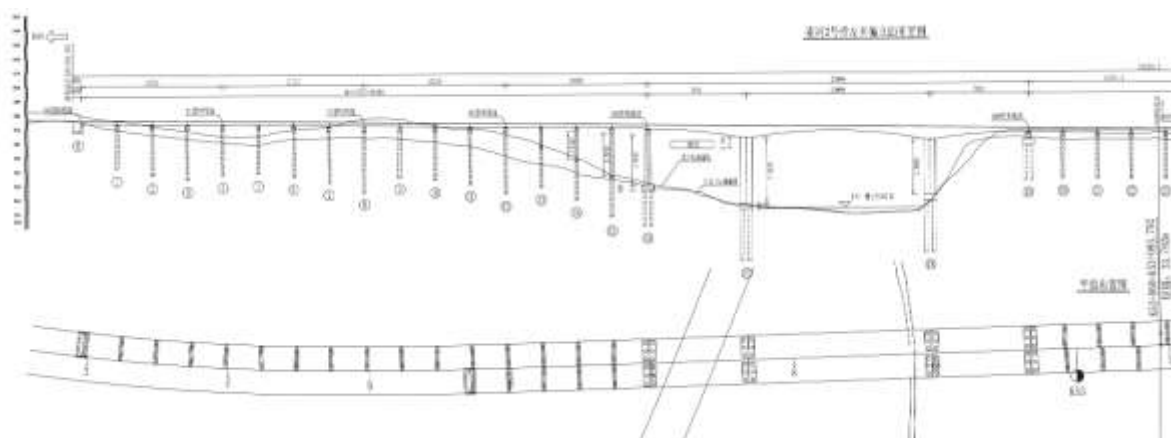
南河二号特大桥（左幅）立面布置图
